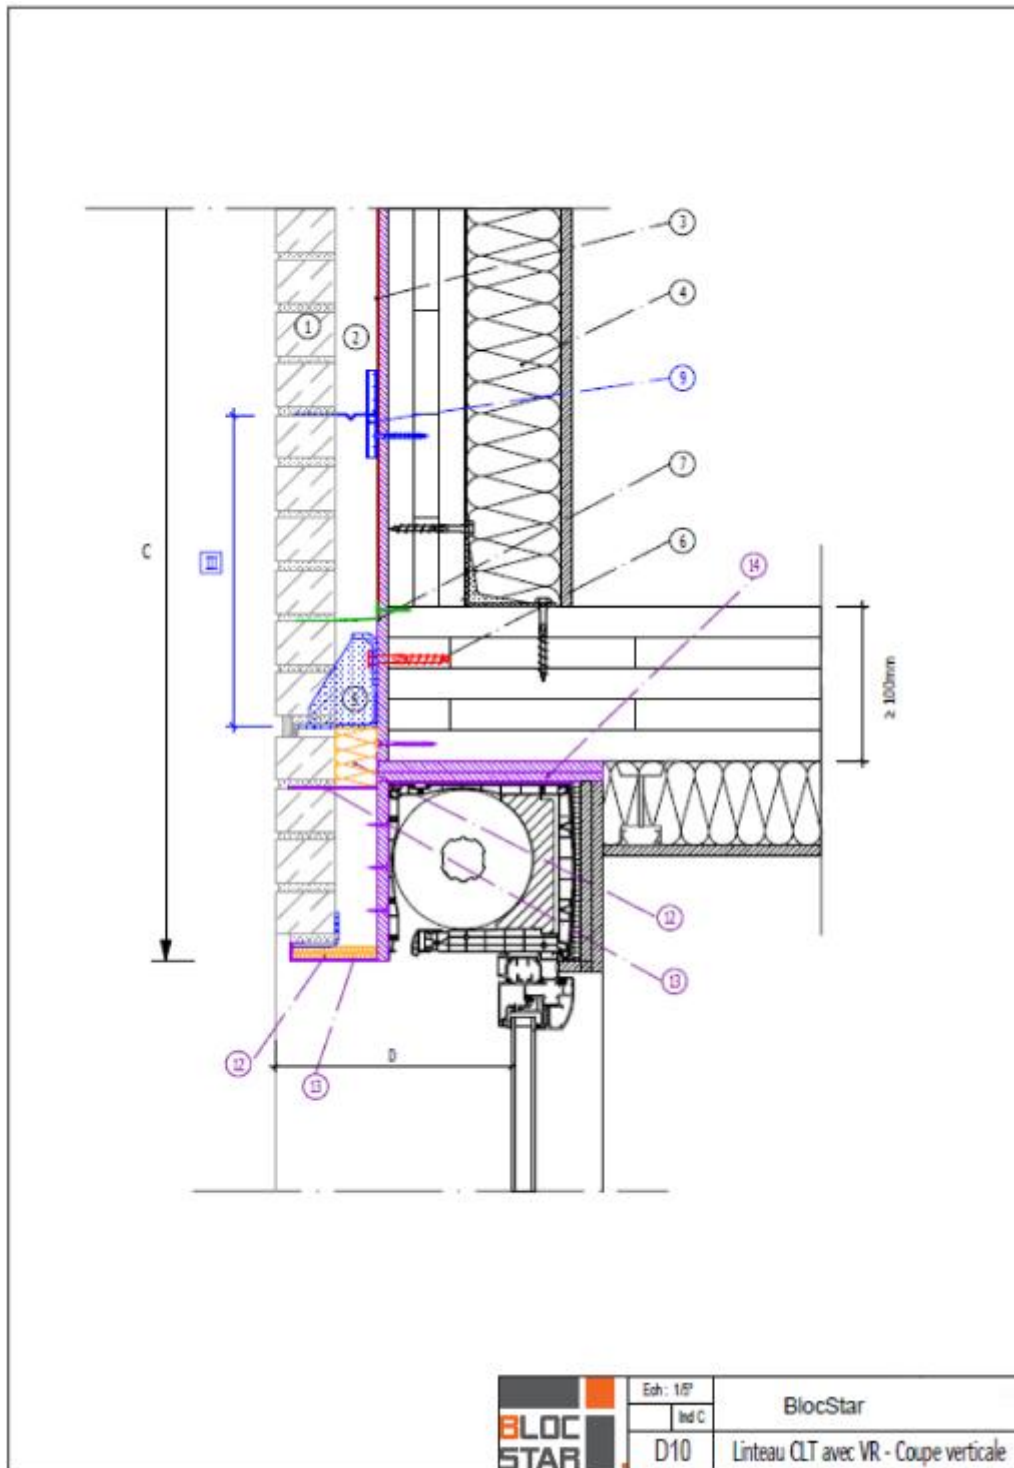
Traitement des embrasures – coupe verticale en linéau (CLT avec CVR)
